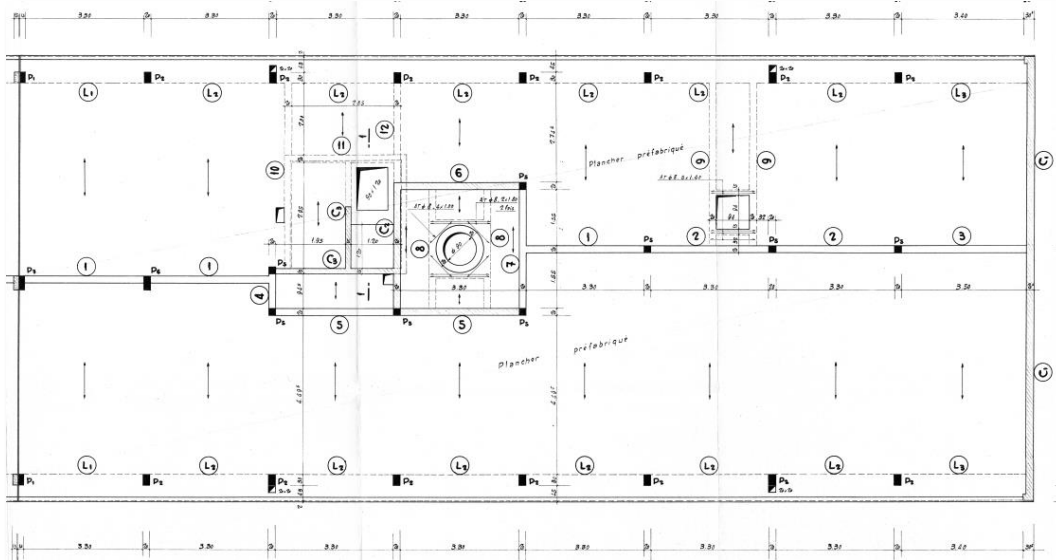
Vue en plan terrasse bloc 7, extrait BA147
